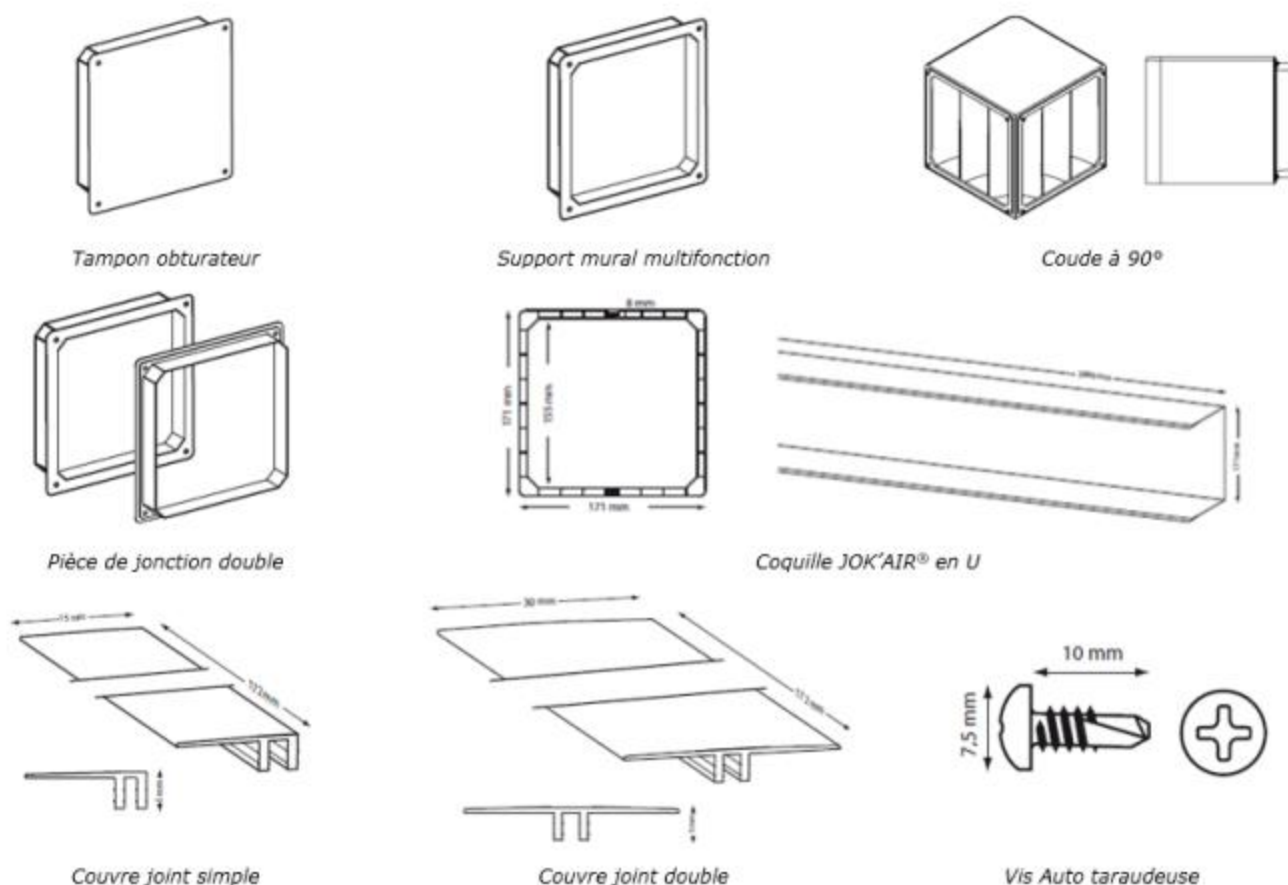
Conduits horizontaux JOK'AIR – Eléments constitutifs
